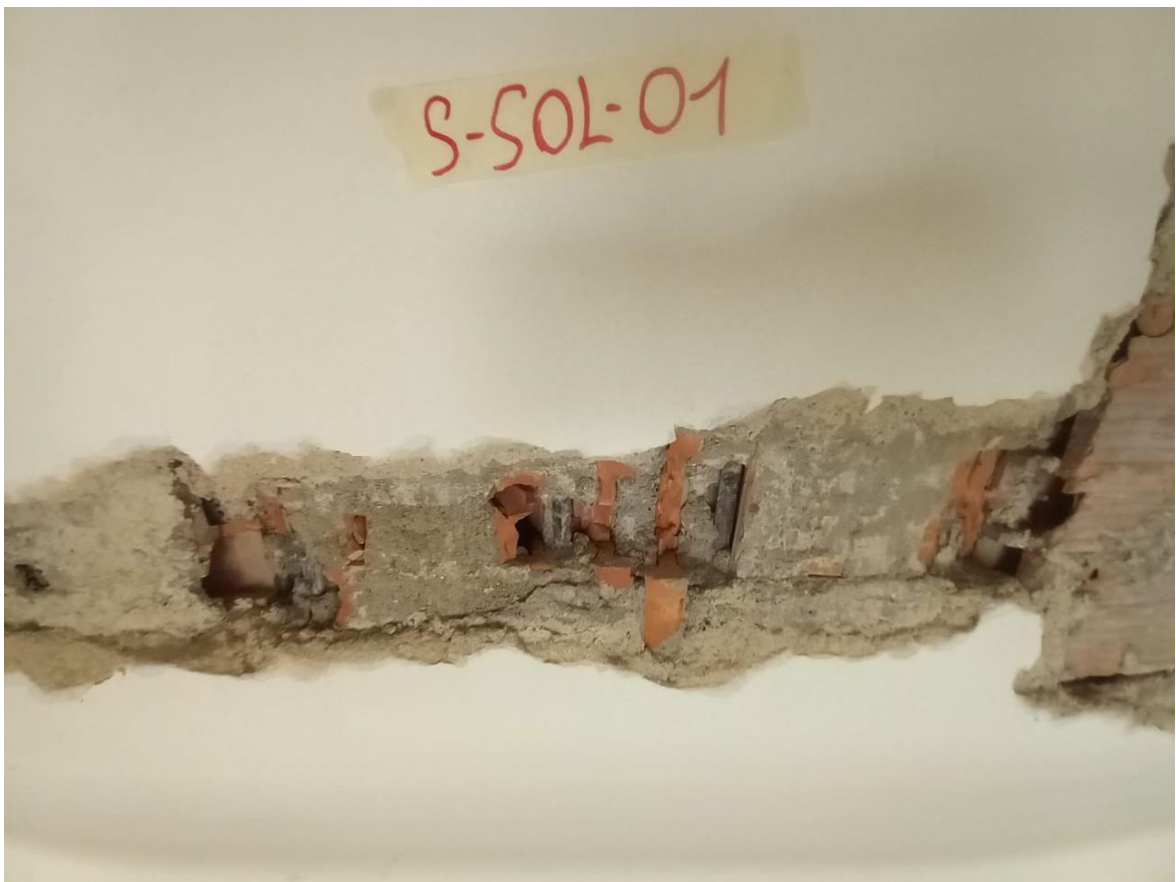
Rappresentativa Ispezione diretta su solaio denominata "S_SOL_01"
